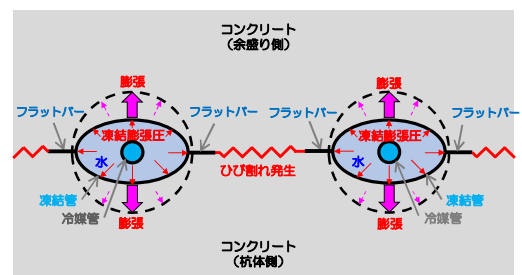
凍結膨張圧によるひび割れ発生のしくみ
